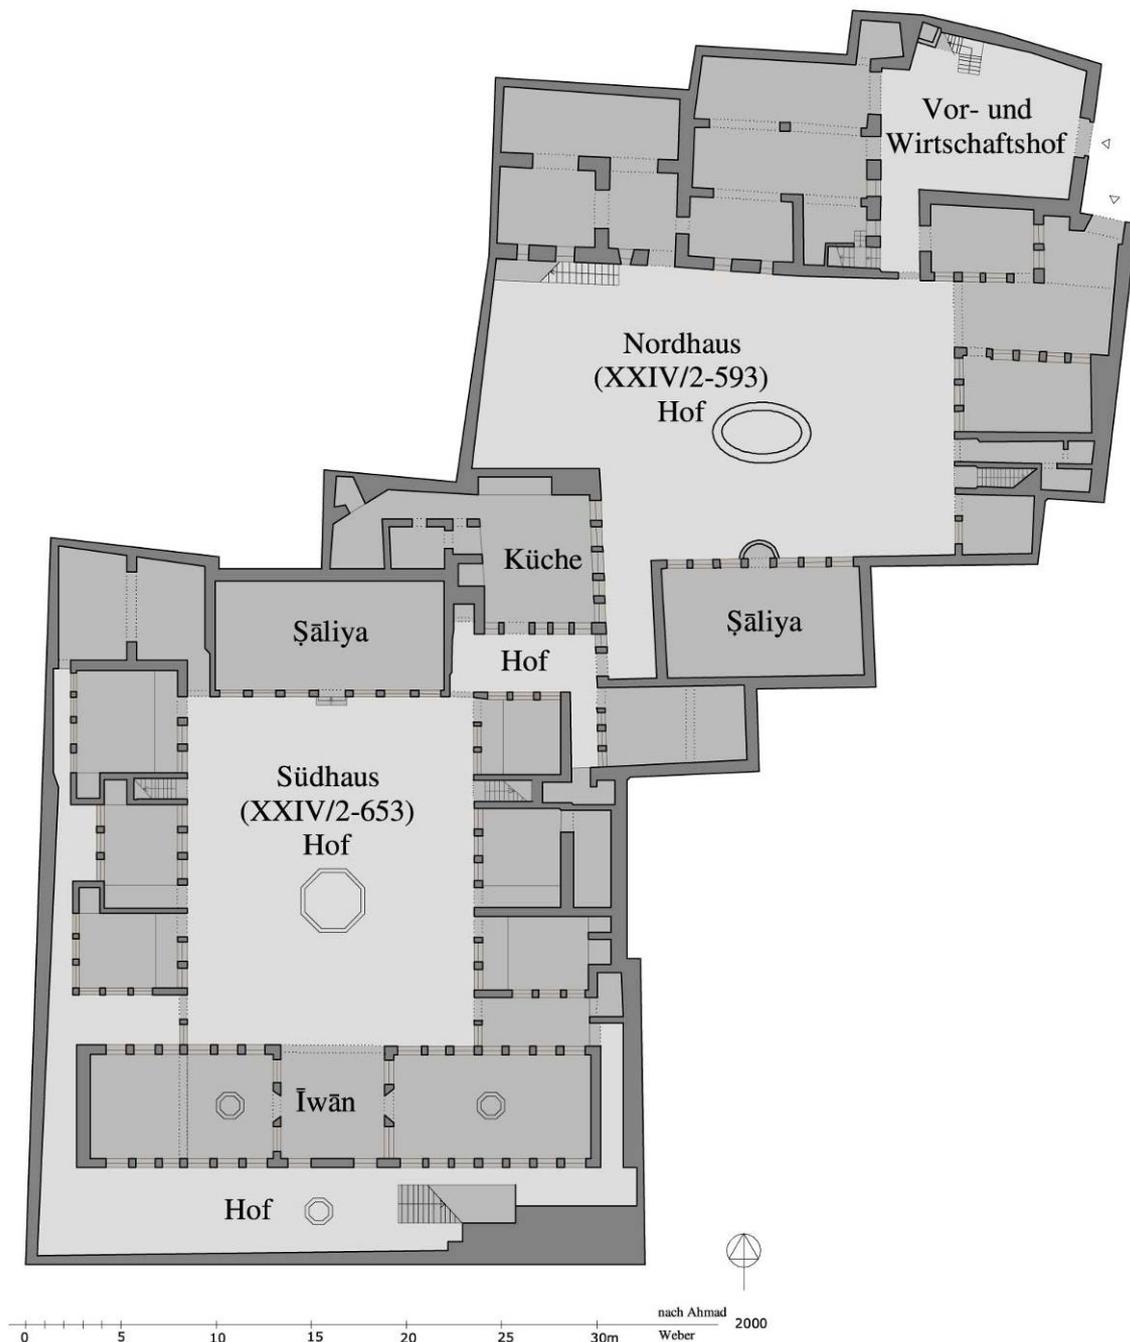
Bayt al-Bārūdī, Grundriss
